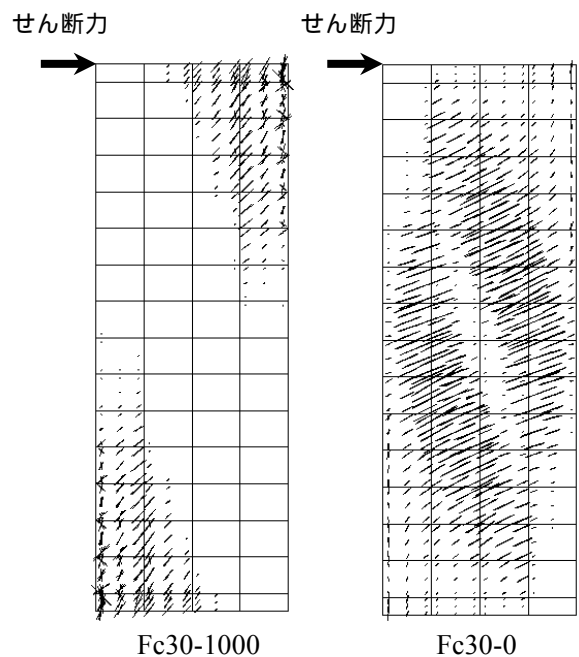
ひび割れひずみ図 (水平変位 2 mm)
